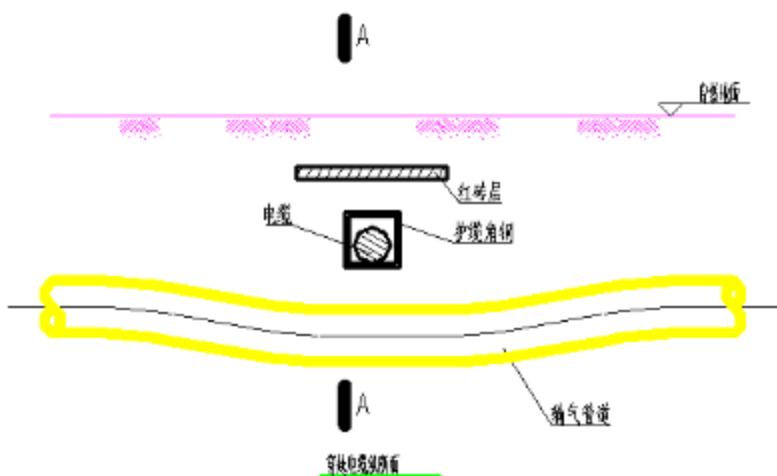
管道与光（电）缆交叉穿越断面示意图
